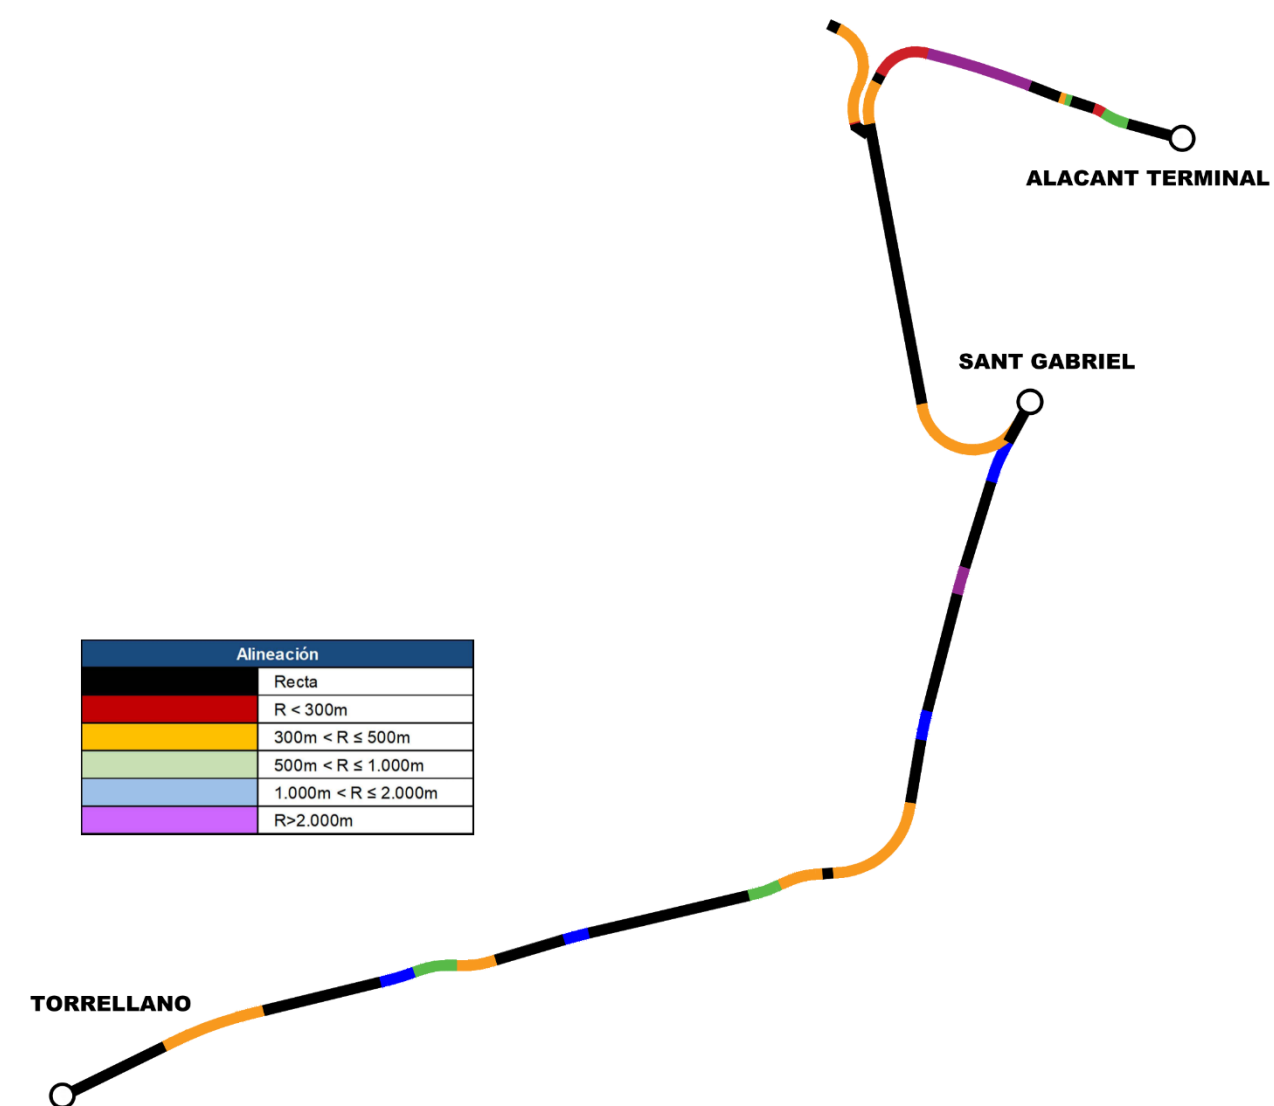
Planta de trazado Alacant Terminal – Torrellano. Radios de curvatura existentes.
